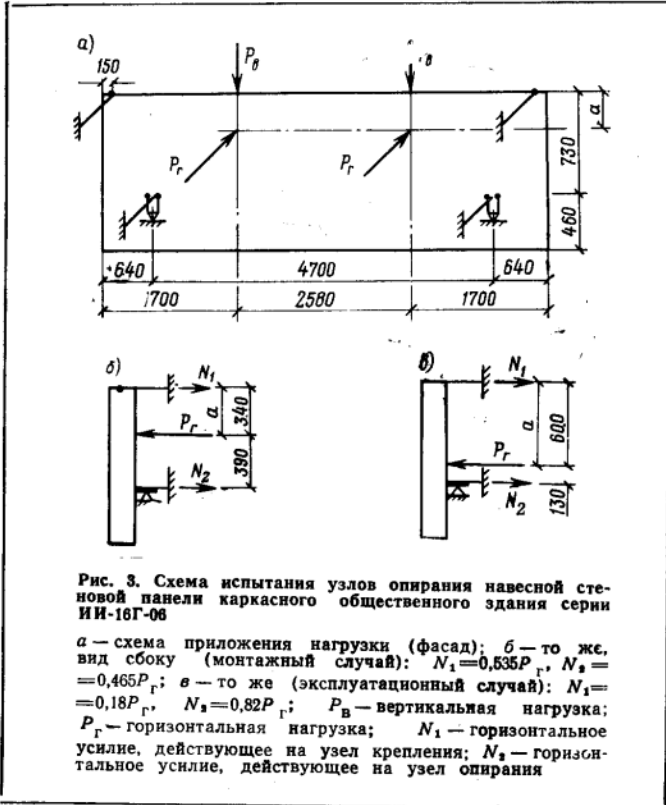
Схема испытания узлов опирания навесной стеновой панели каркасного общественного здания серии ИИ-16Г-06
